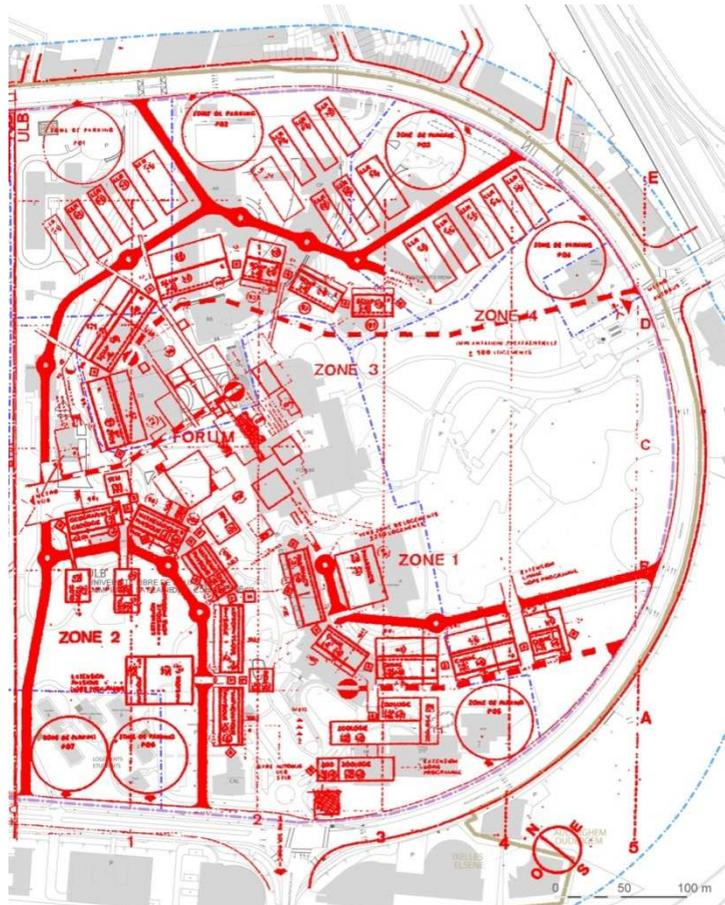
Superposition du plan masse de 1970 et le plan de la situation existante (source : Département des Infrastructures Projets et Constructions – ARTER)
